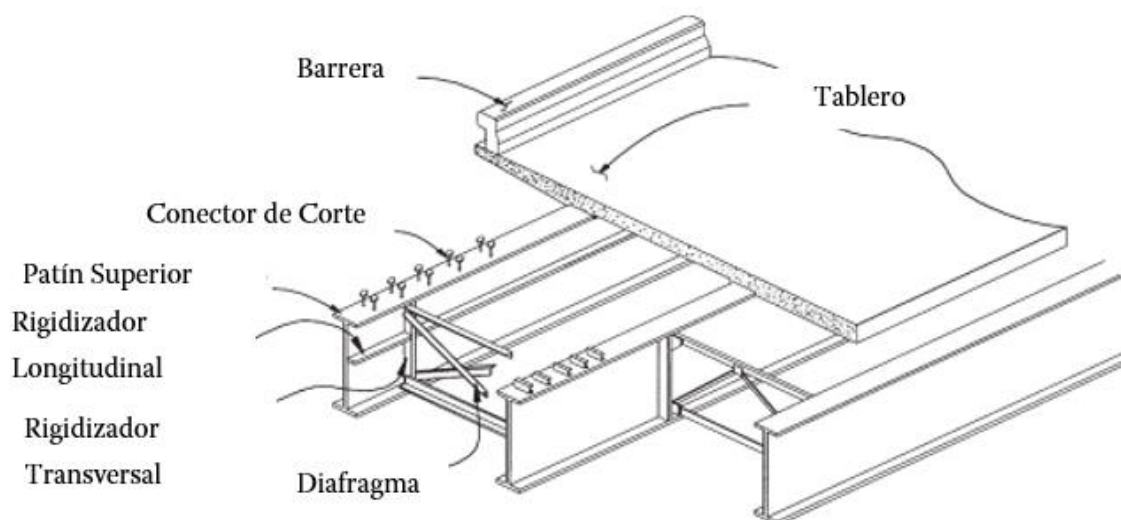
Sección de la superestructura de un puente apoyado en vigas de acero
